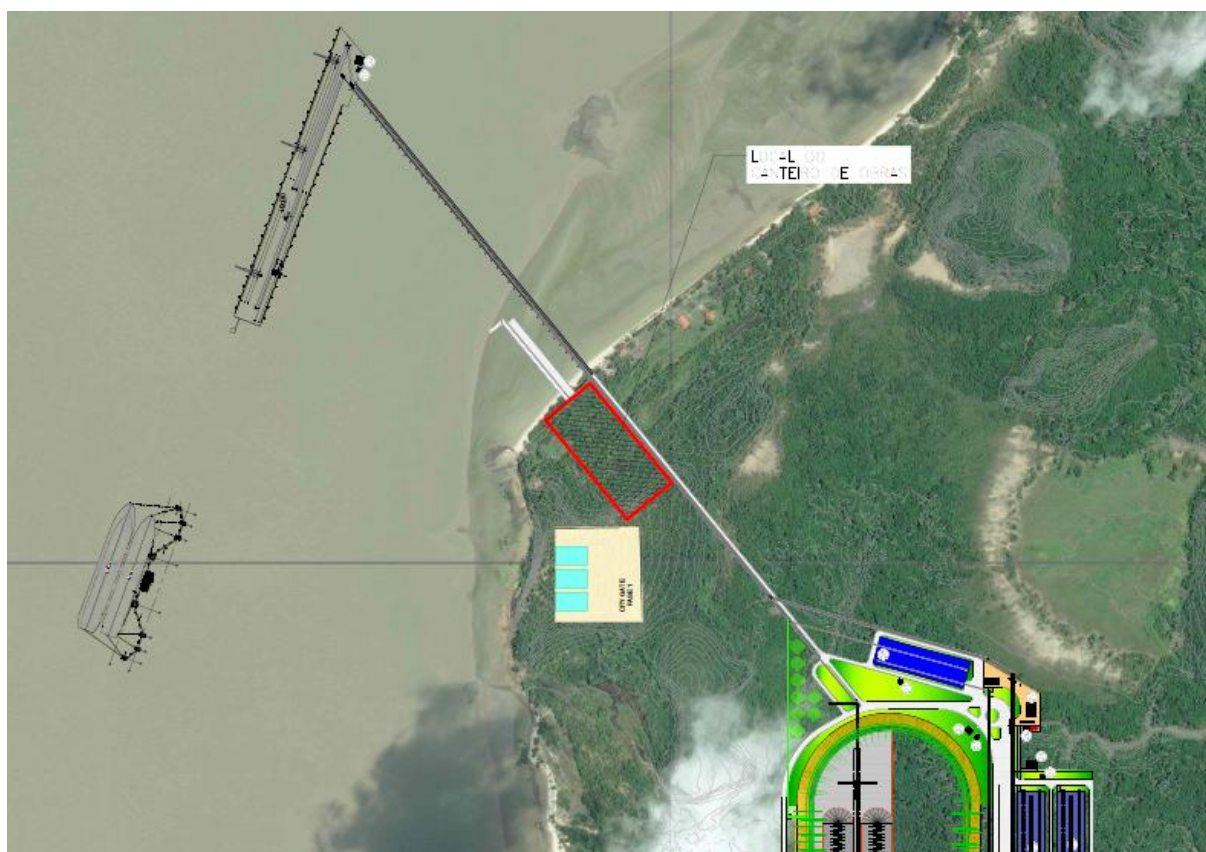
Localização do canteiro de obras. Fonte: GRAF (2024 - CANTEIRO DE OBRAS Terminal Portuário_00).
